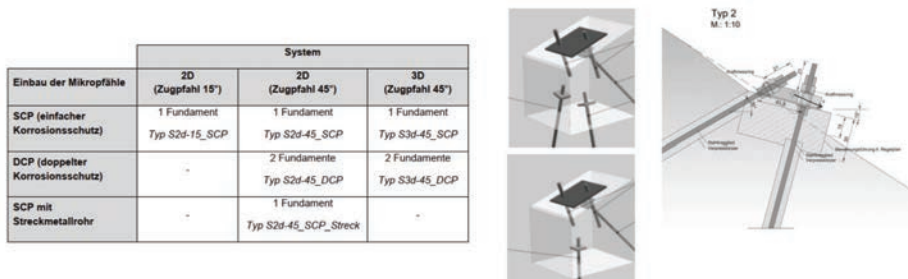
, (a) Versuchsplan mit acht Testfundationen SBB/RhB
